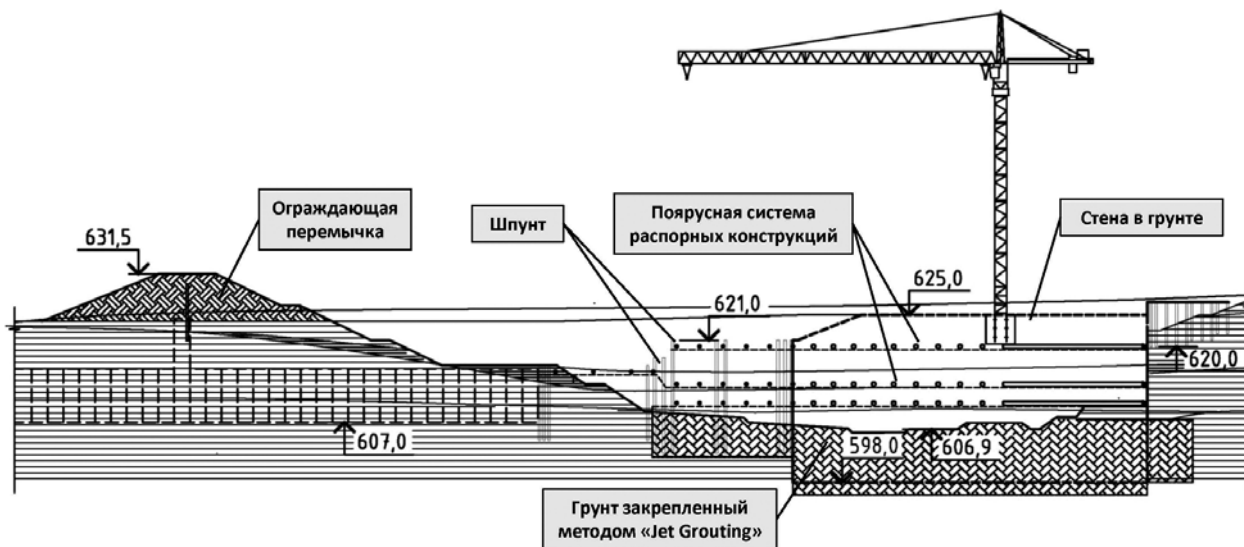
Разрез по котловану в ходе строительства нового здания ГАЭС
